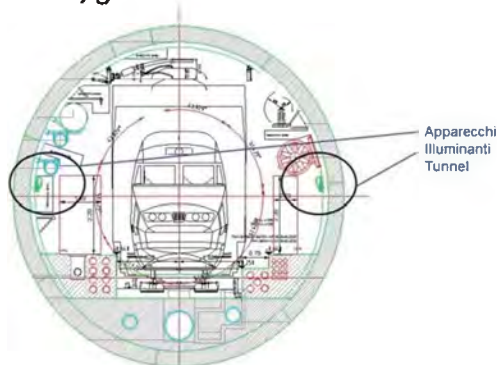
Disposizione degli apparecchi illuminanti nella sezione tipo
